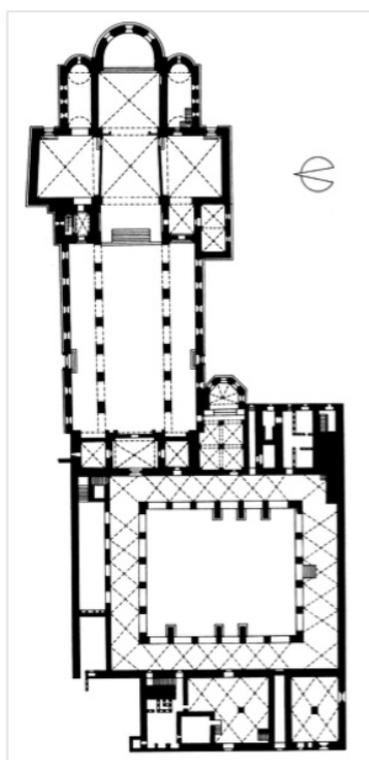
Planta de la Liebfrauenkirche de Halberstadt
